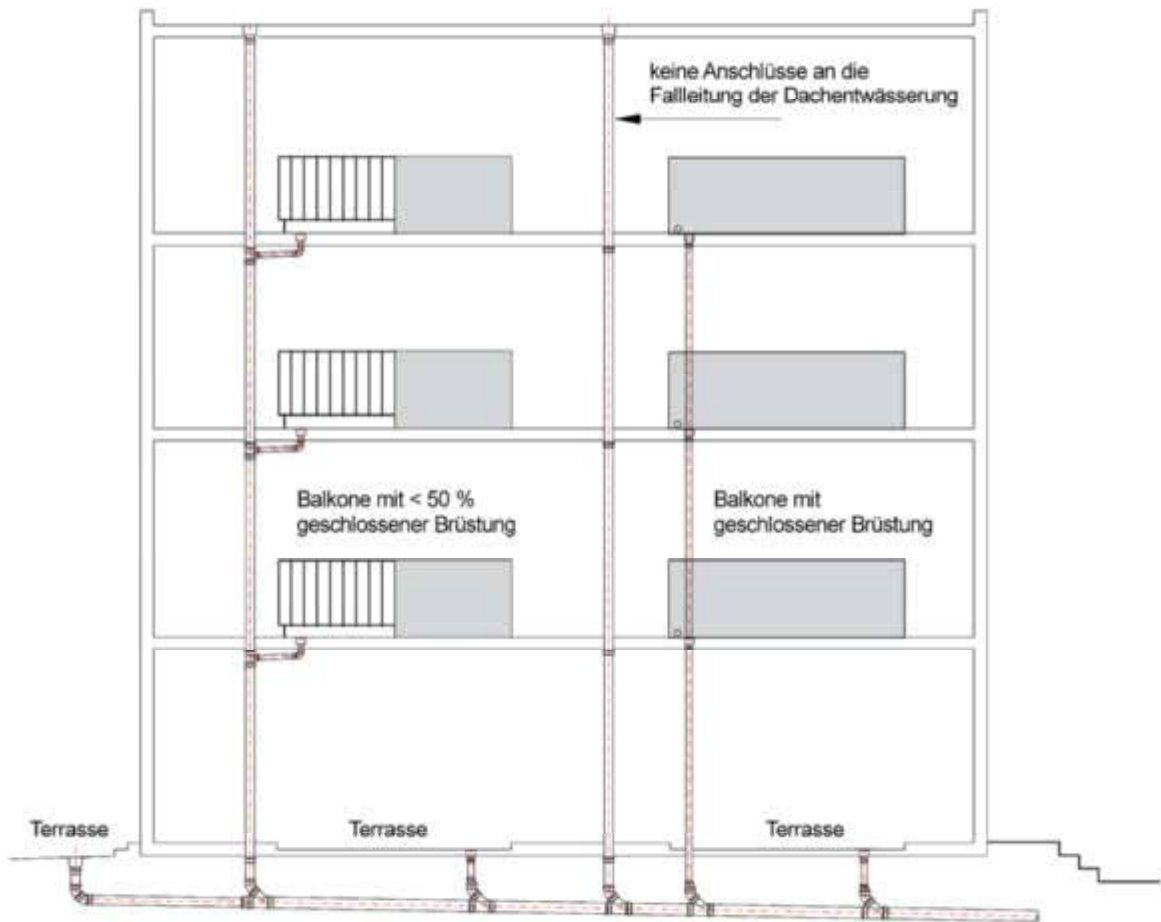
Balkonentwässerung mit geschlossener und offener Brüstung
